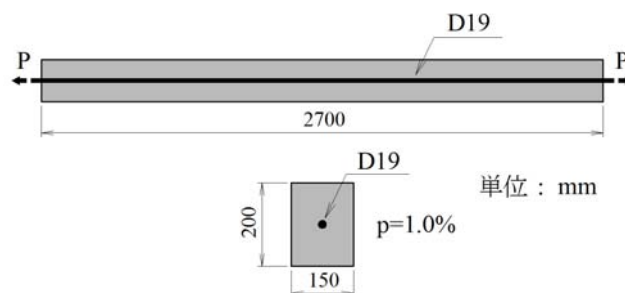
一軸引張供試体の形状寸法および配筋状況
